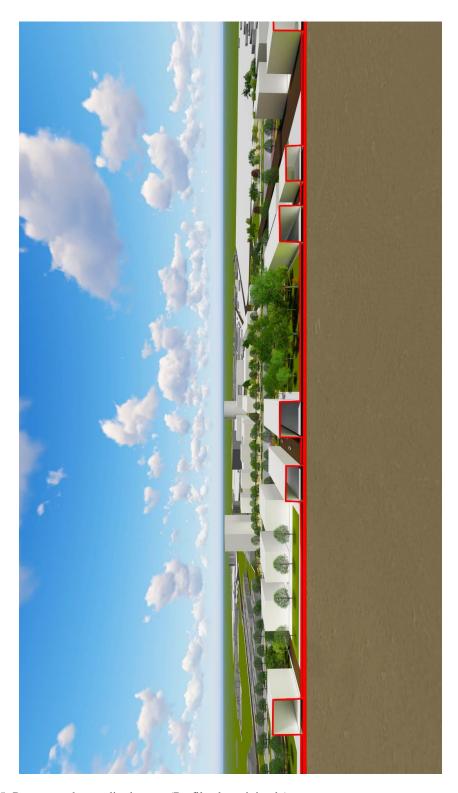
Propuesta de estudio de caso (Perfil sobre vivienda)
